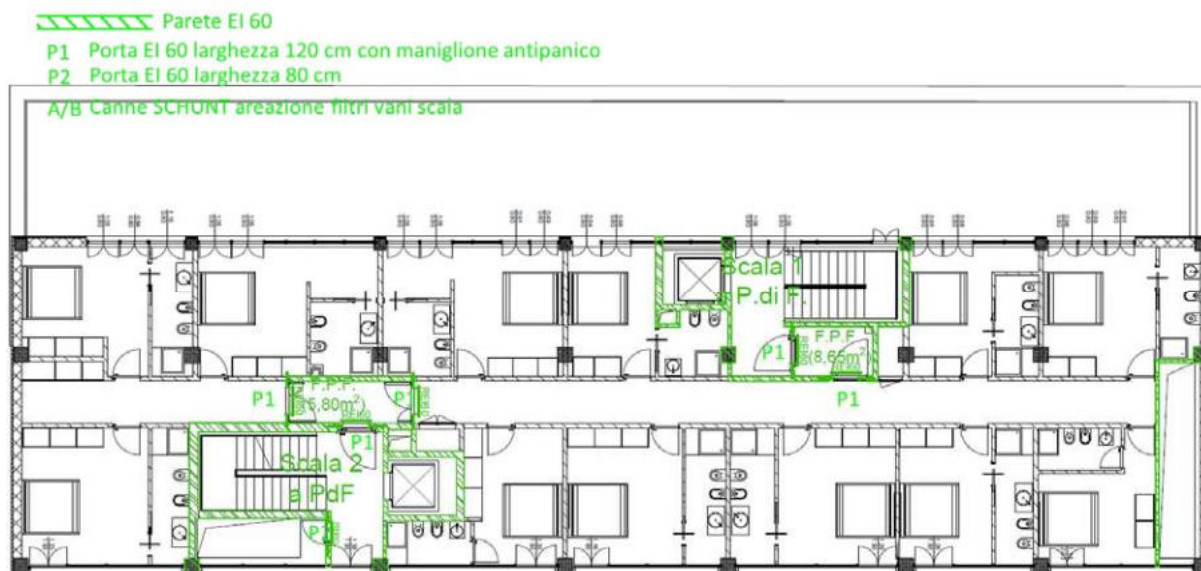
Pianta piano Terzo – Layout distributivo.
